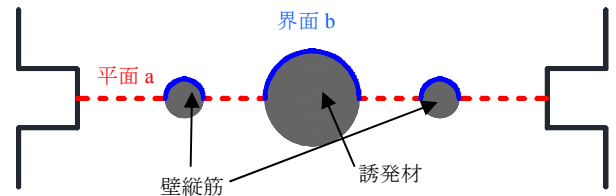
目地部のひび割れ面 (試験体断面図)
